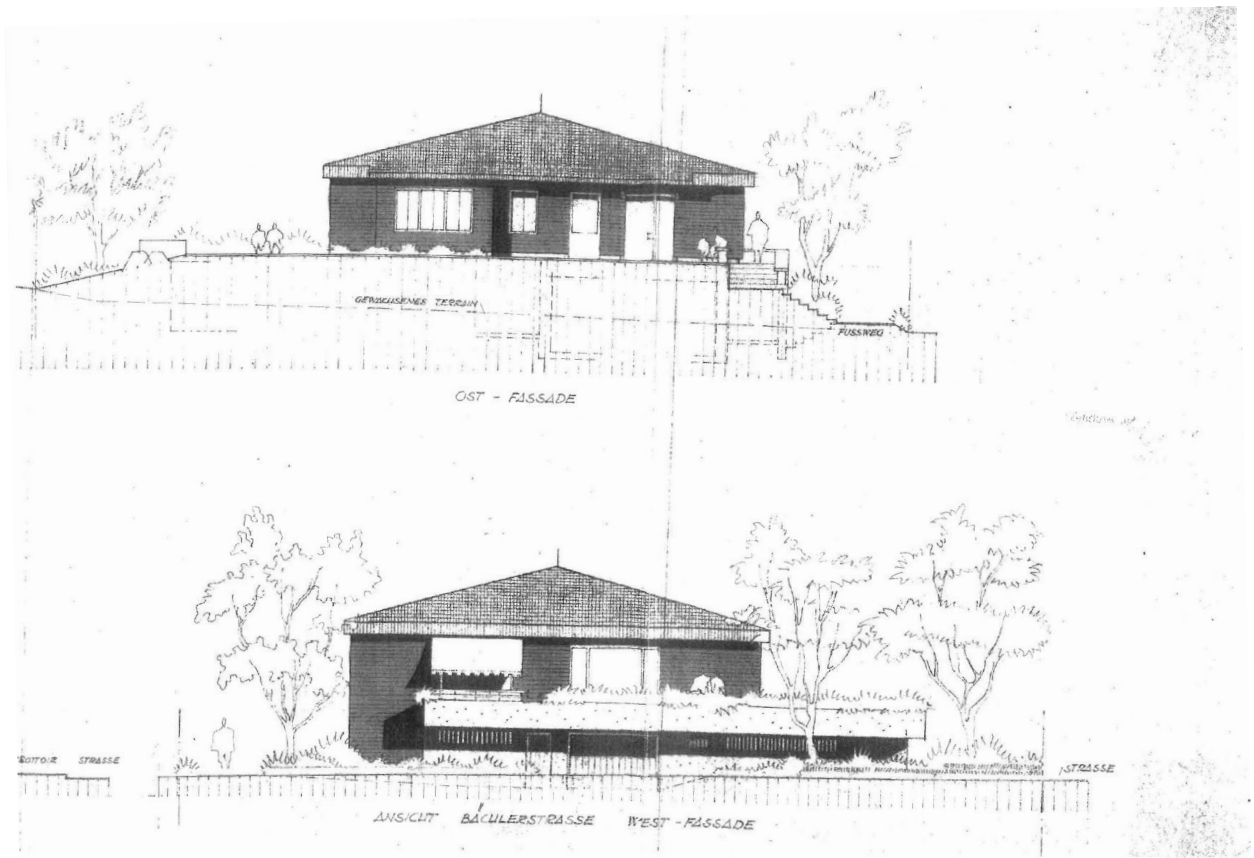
Fassadenpläne Kindergarten Bächler 1967, A.Binggeli Arch. Kilchberg, Fassadensanierung 1989, Hans Stocker Architekt Zürich
